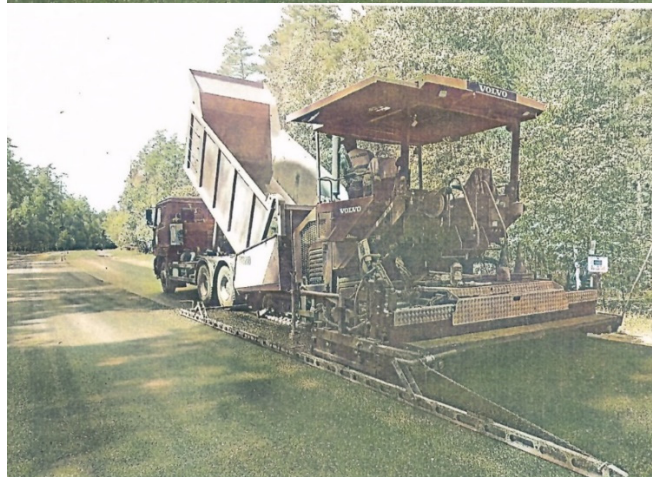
Укладка верхнего слоя асфальтобетонной смеси
